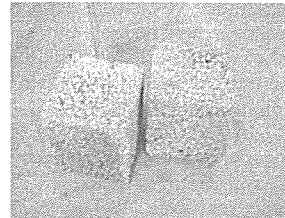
Analizlerde kullanılan boşluklu ve lamba zıvanalı blok elemanı formu.
